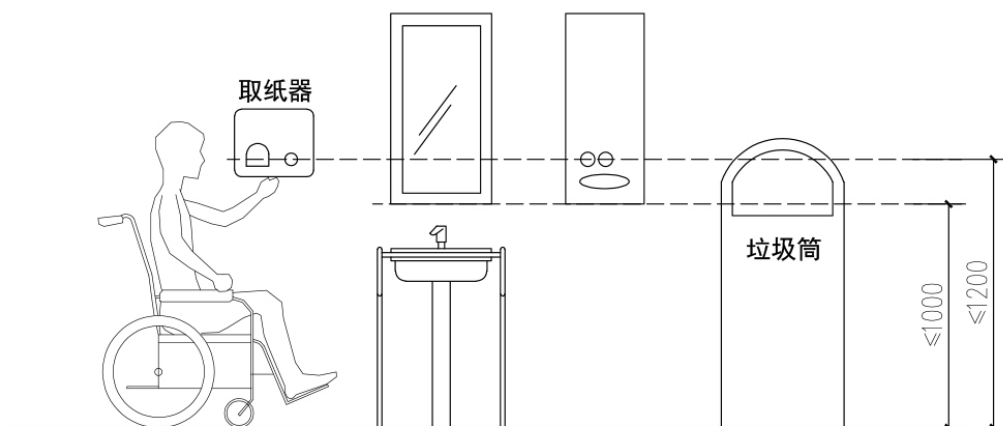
无障碍卫生间设施位置示意图 (mm)
